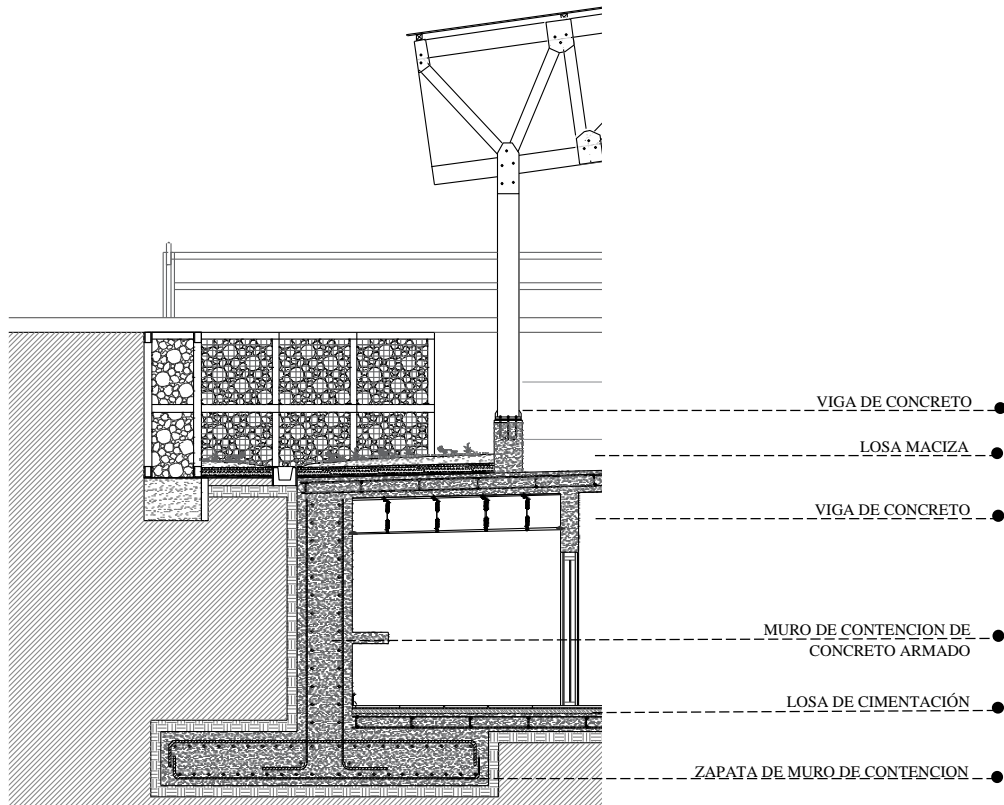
Corte constructivo tipo 1 - zona industrial. Fuente: propia.
